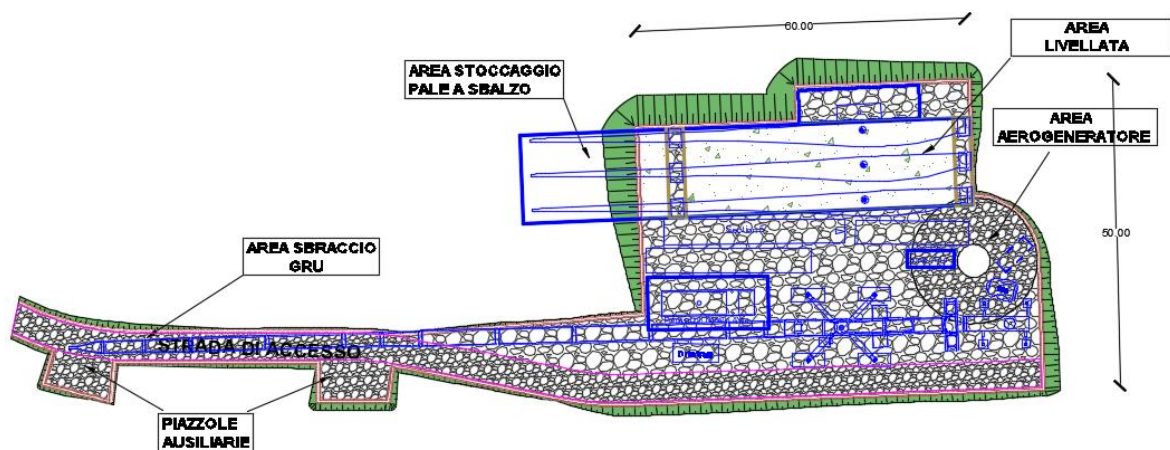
Planimetria piazzola tipo in fase di esecuzione lavori
